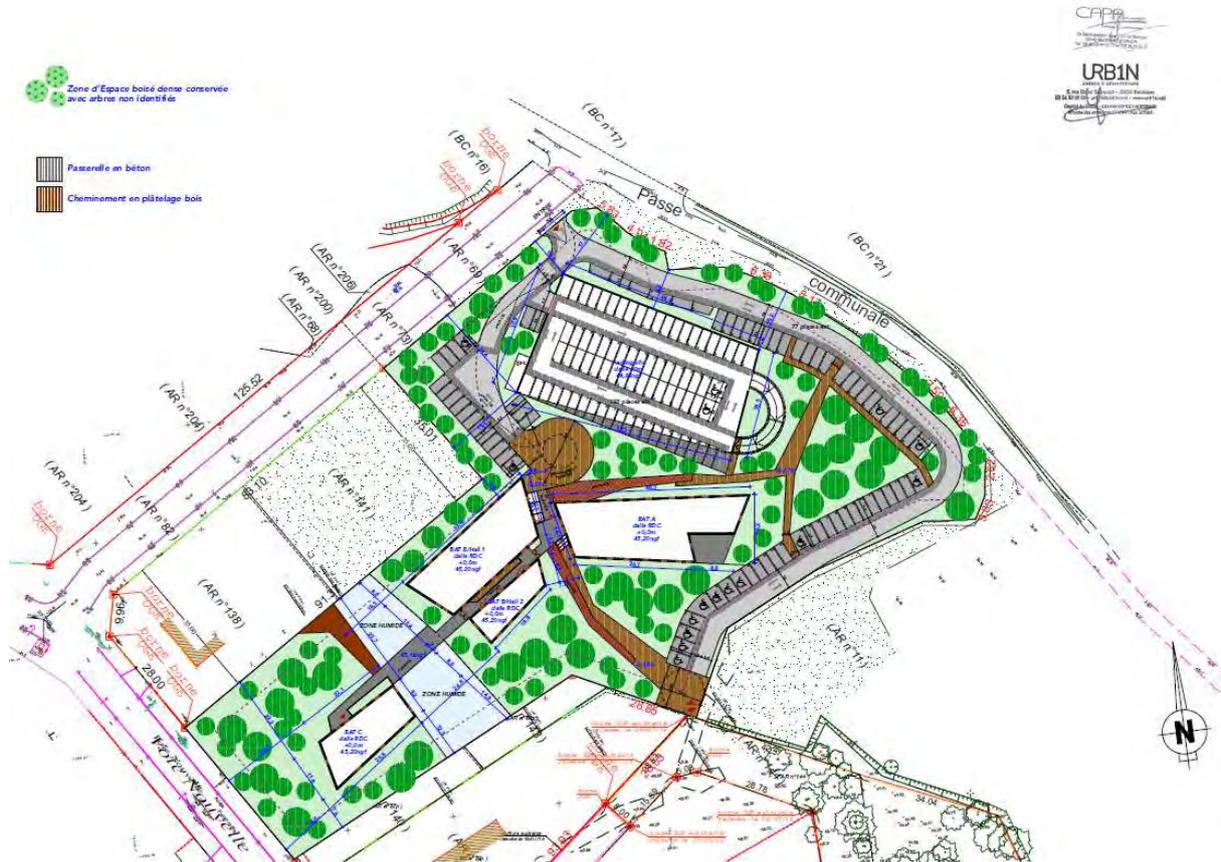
Plan masse (Source : Urb1n 19/05/2020)
